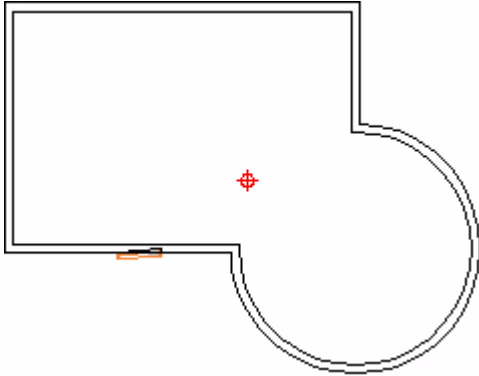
Tabiquería Extruida - Ambiente de Modelaje - Vista Planta
